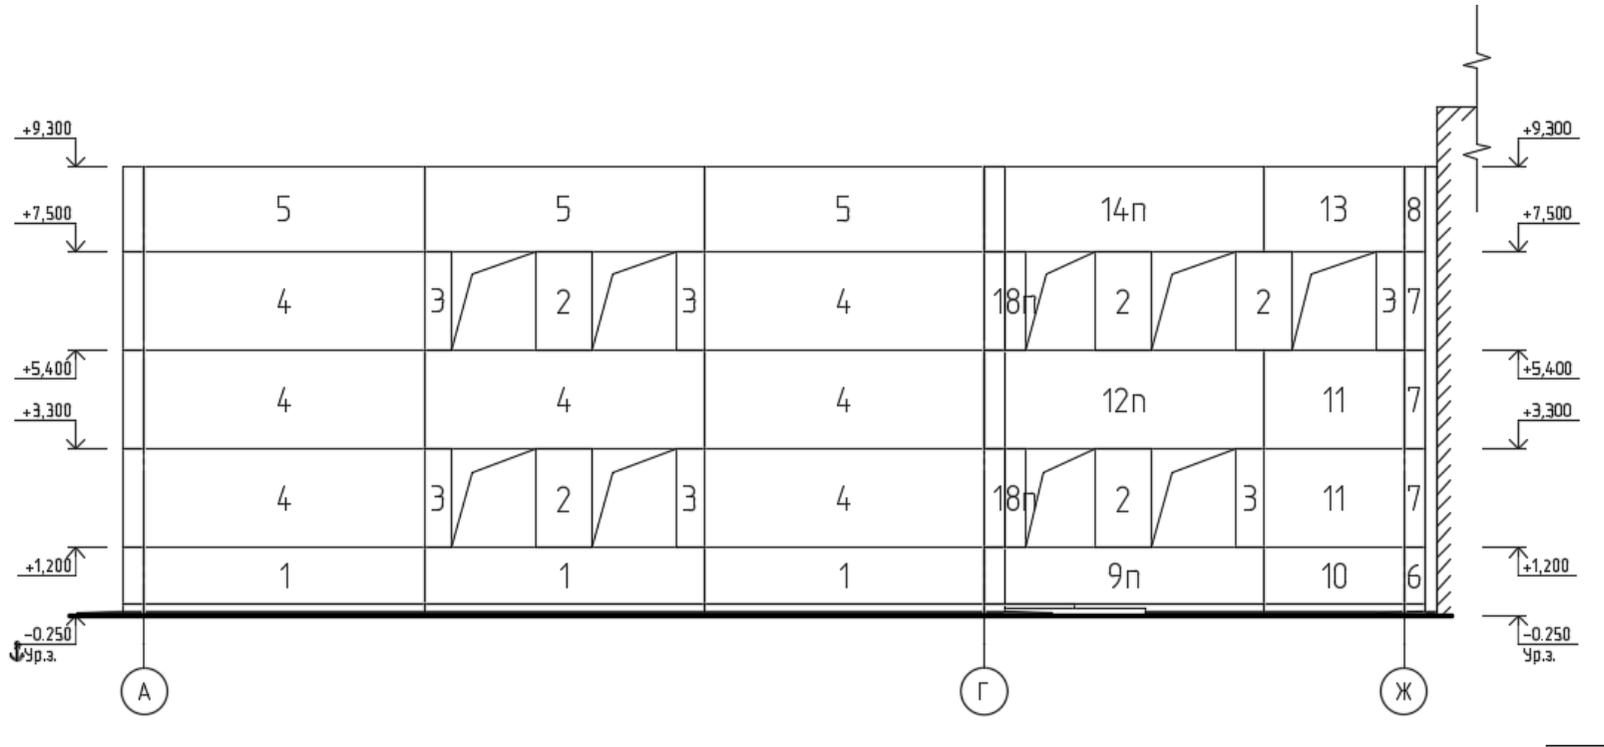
Схема расположения стеновых панелей на фасаде А-Ж
